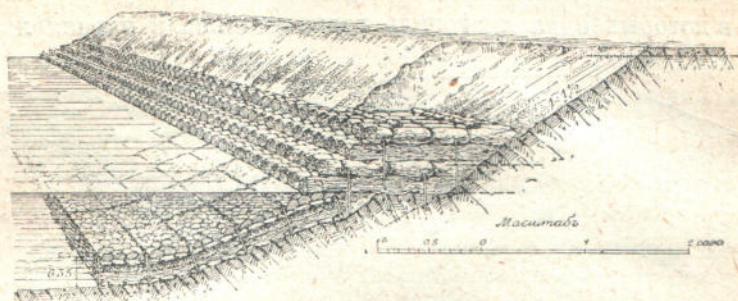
Берегоукрепительная стенка из фашивной кладки.
